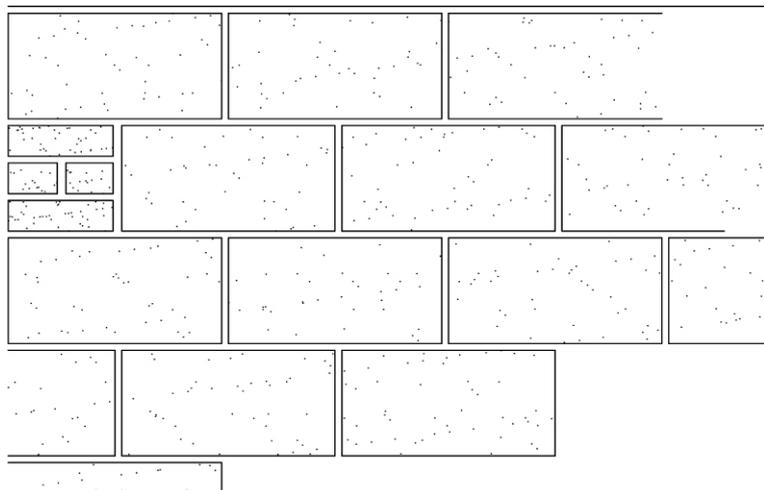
Arremates no canto da alvenaria com 1/2 bloco ou com tijolos
